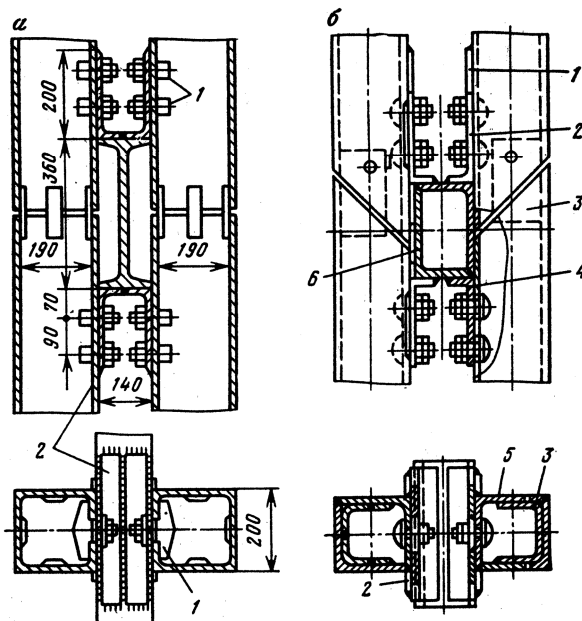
Схема крепления и стыковка коробчатых проводников: а - к расстрелу из двутавровой балки, б - к расстрелу коробчатого профиля
